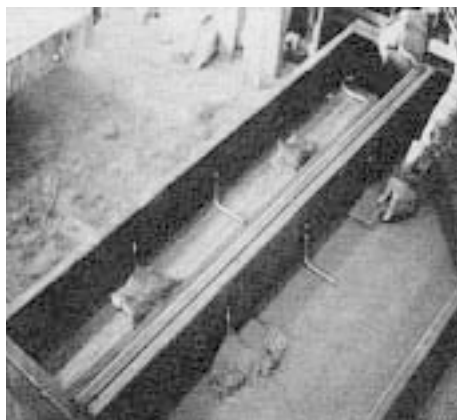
Enrijecimento metálico leve em painel em GRC (PCI, 1994).
